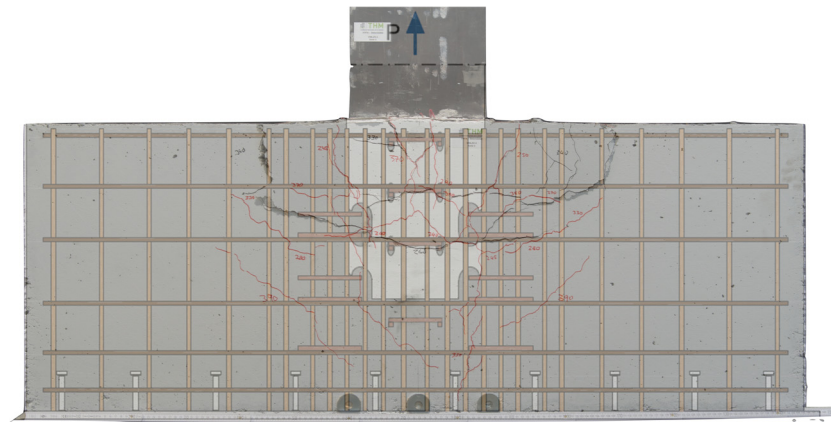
Darstellung der Rissentwicklung mit Bewehrungsführung im Experiment VR5-ZV-3
